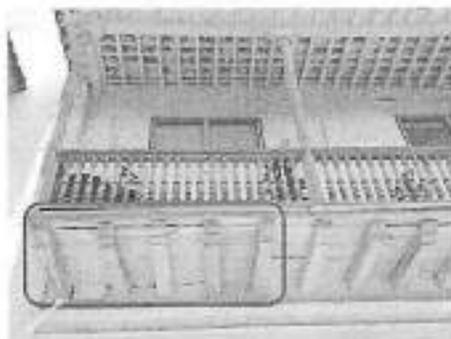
Zona A-1. Pérdida de horizontalidad en perímetro del balcón (Fuente: Autor)
